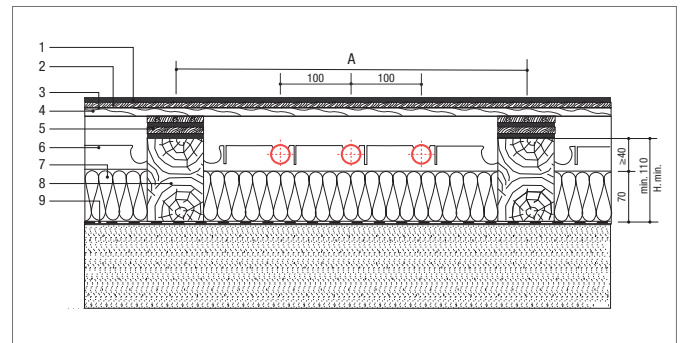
Estructura de la calefacción para pavimento elástico
